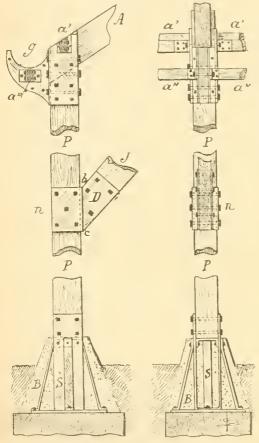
Assemblage des arbalétriers et des aisselliers sur les poteaux.
